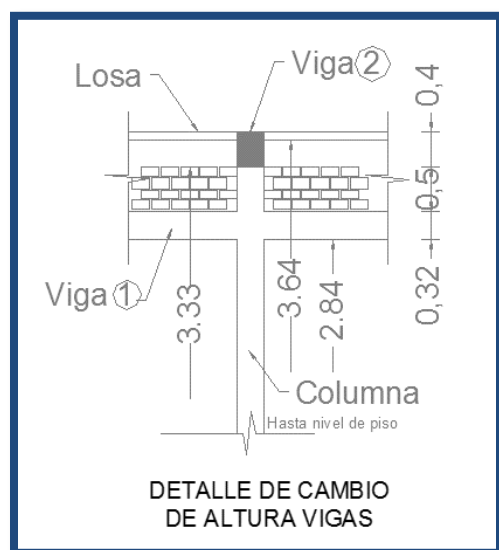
Sección transversal de losa edificio #2. Fuente: Levantamiento estructural
